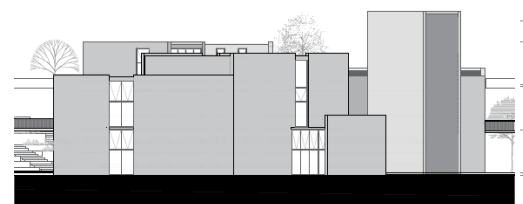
Sección B – Fachada Este. Caraguay (2020)
